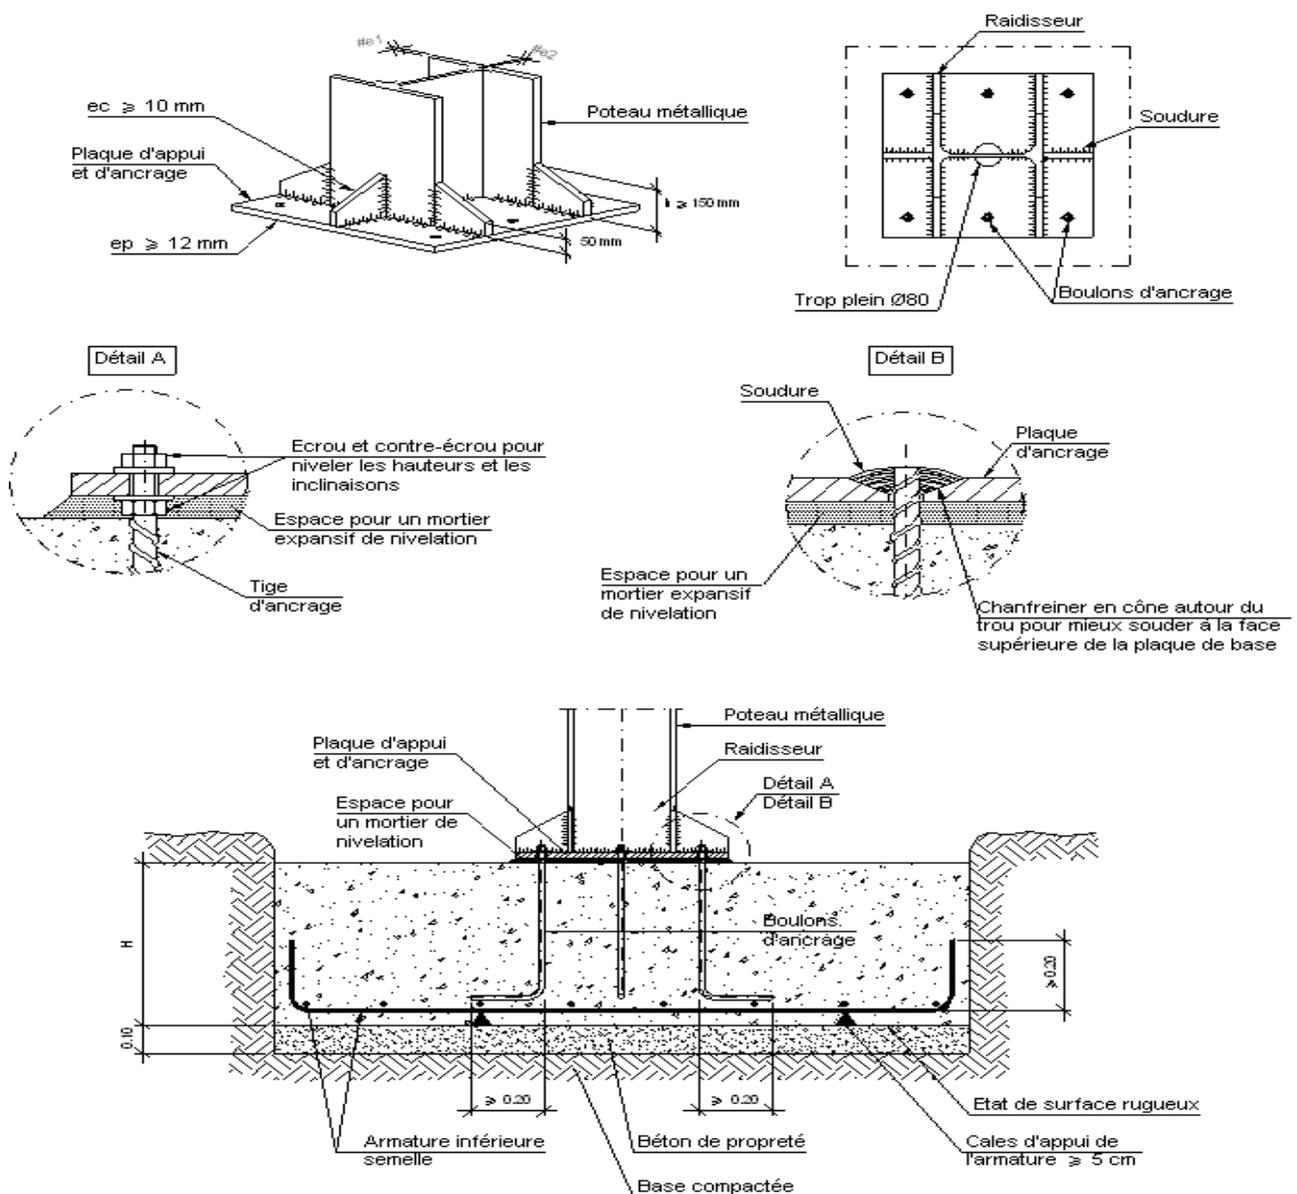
Détail de la jonction poteau métallique –fondation en béton armé.
